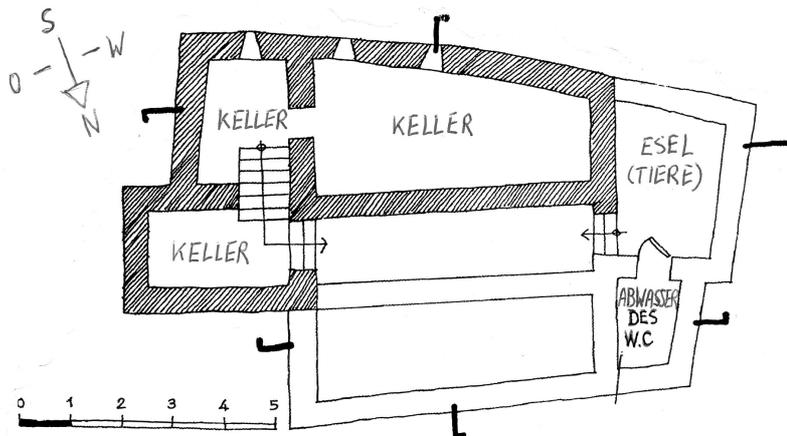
Grundriss des Souterrains des Hauses einer armen Familie
